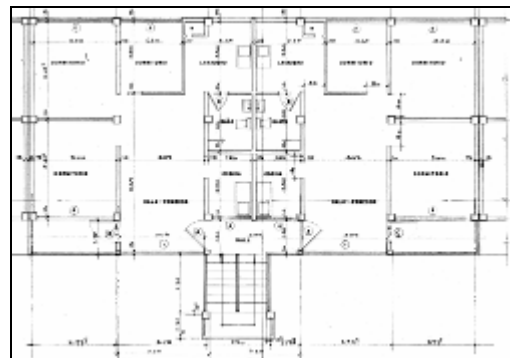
n. Bloque CT-1 Mejorado. Planta
